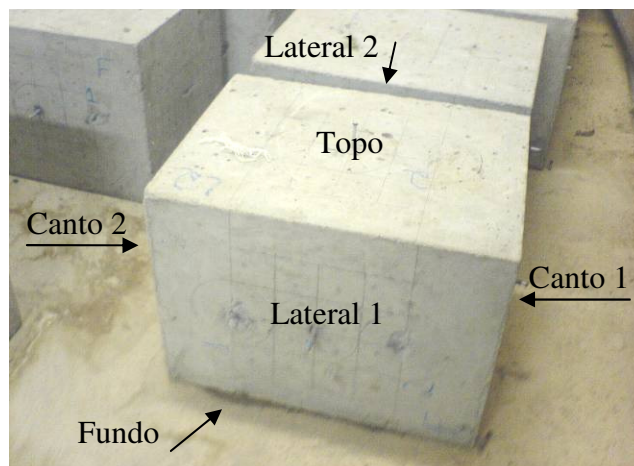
Disposição das faces do corpo-de-prova prismático
